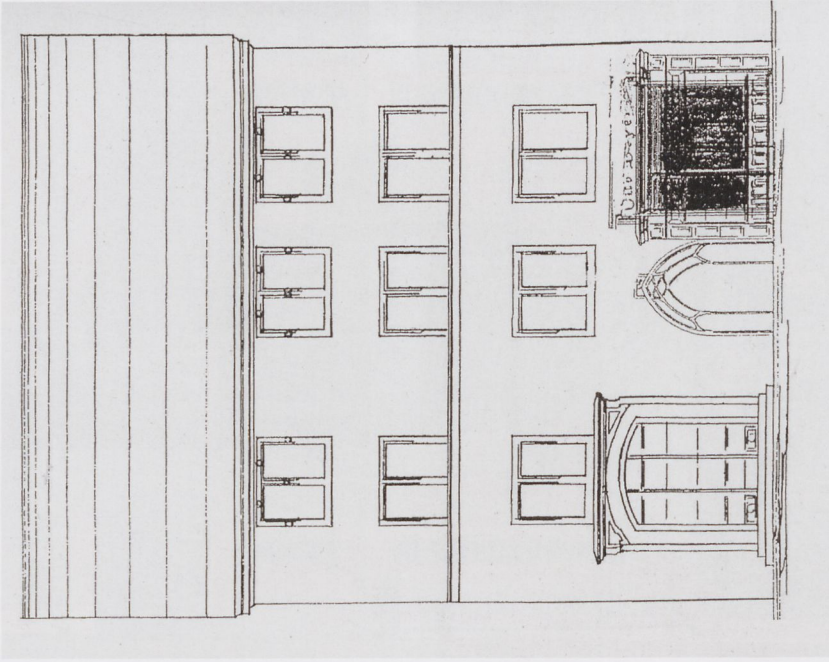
Halle an der Saale, Fassadenaufriß des Hauses Große Ulrichstraße 58, 1882. Stadtarchiv Halle an der Saale, Bauabteilung, Hausakte Große Ulrichstraße 58, Bd. I (Neugebauer, Andreas Günther (2011), S. 106).
